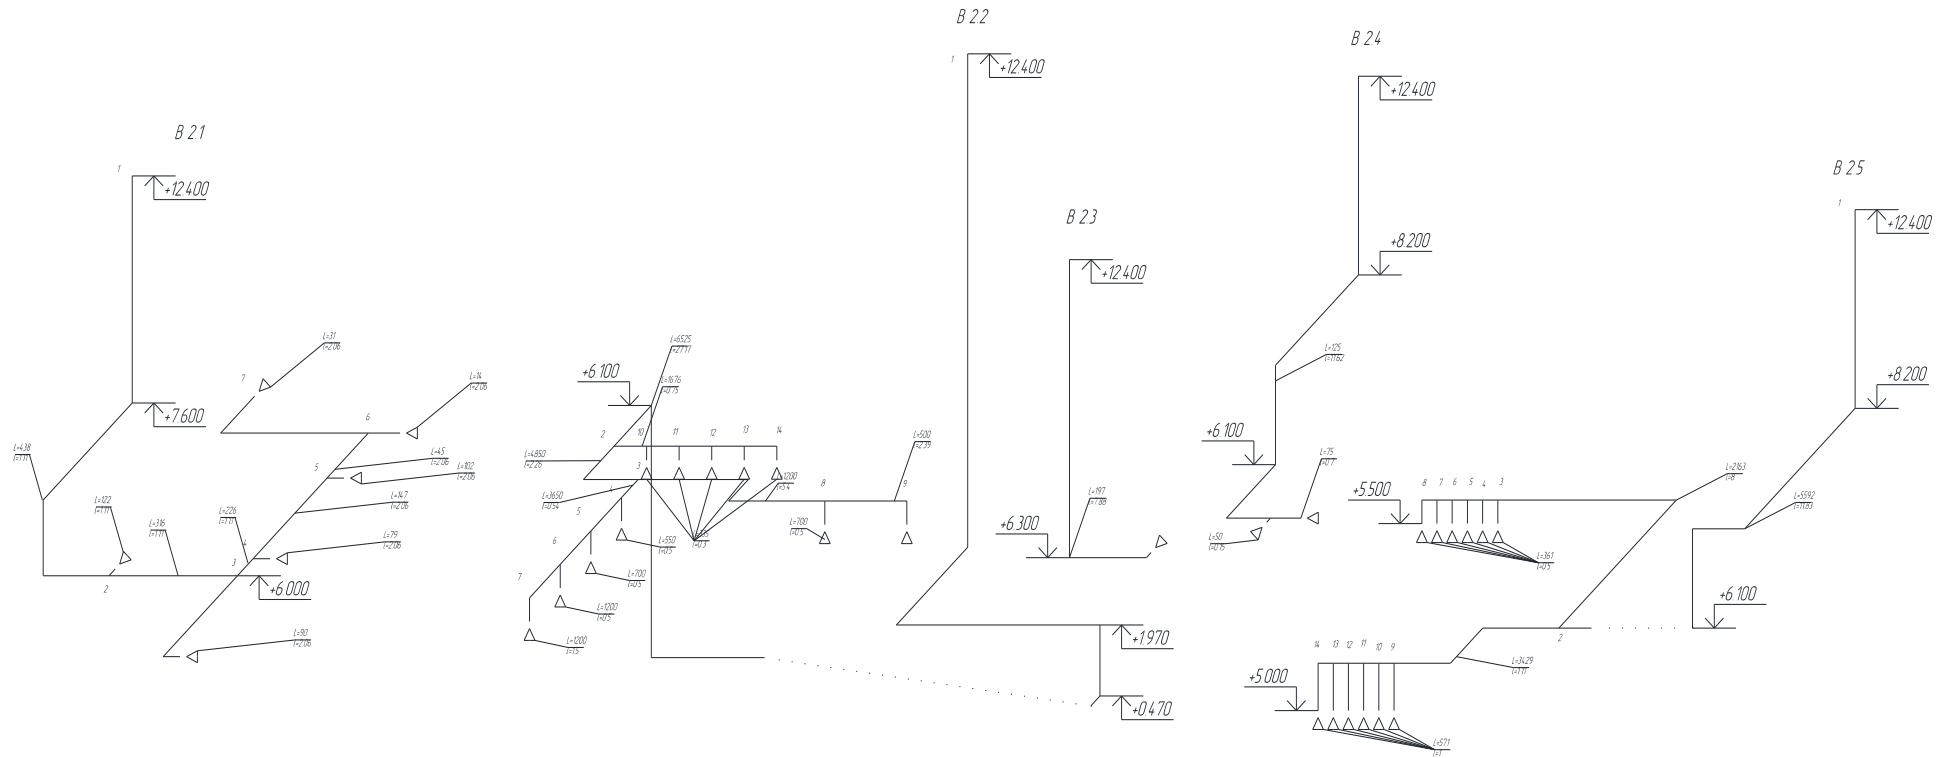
Расчетные схемы систем вентиляции блока №2
